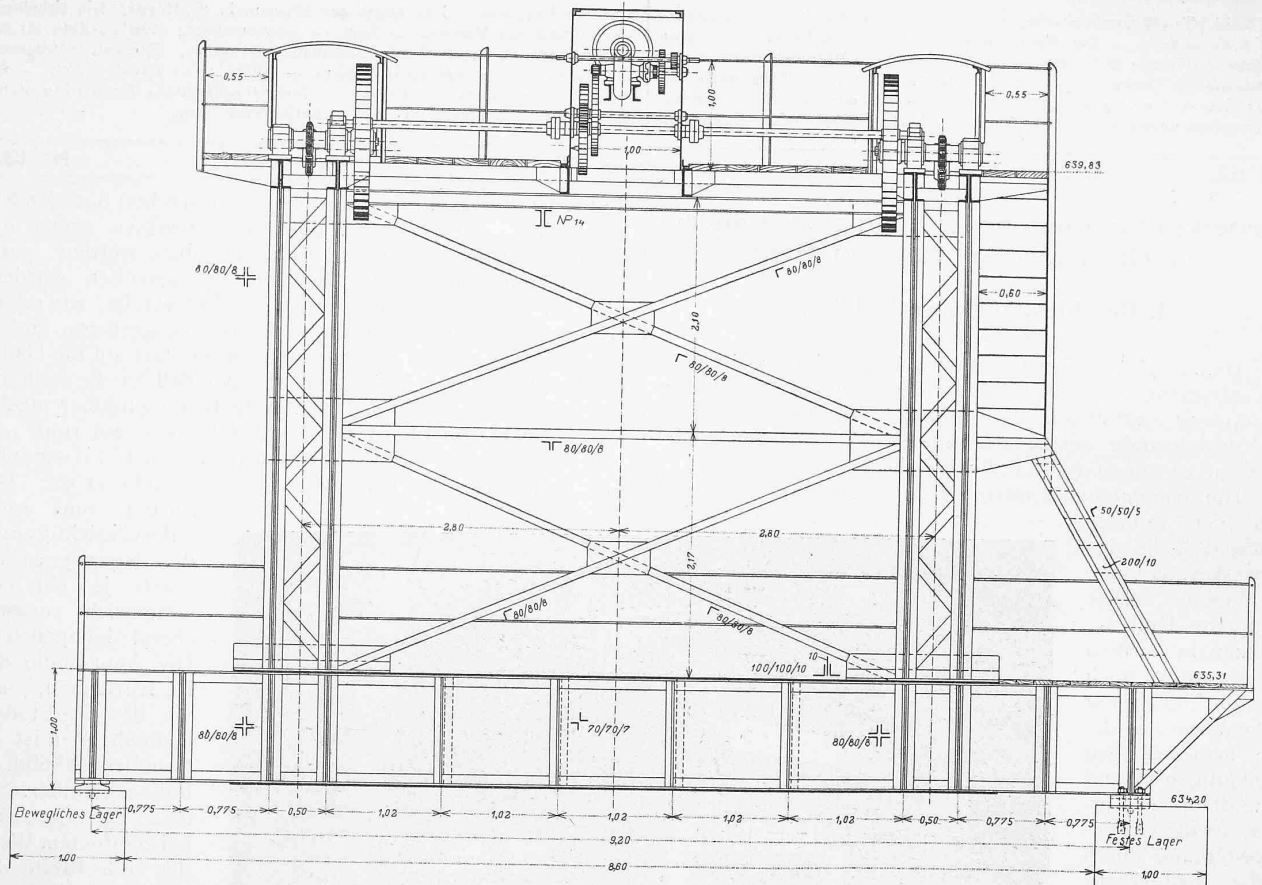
Simme-Wehr. Ansicht des Turmgerüsts für den Grundablass-Schützen-Aufzug. — Masstab 1 : 60.
